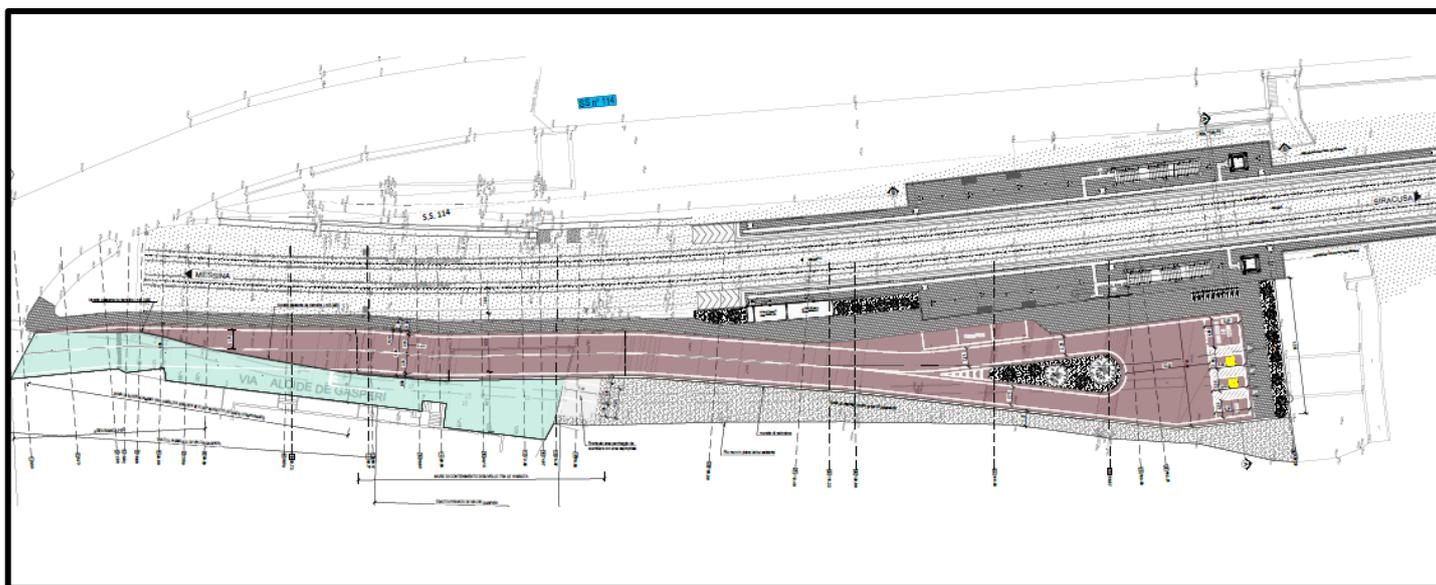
Planimetria di progetto Viabilità di accesso e piazzale
